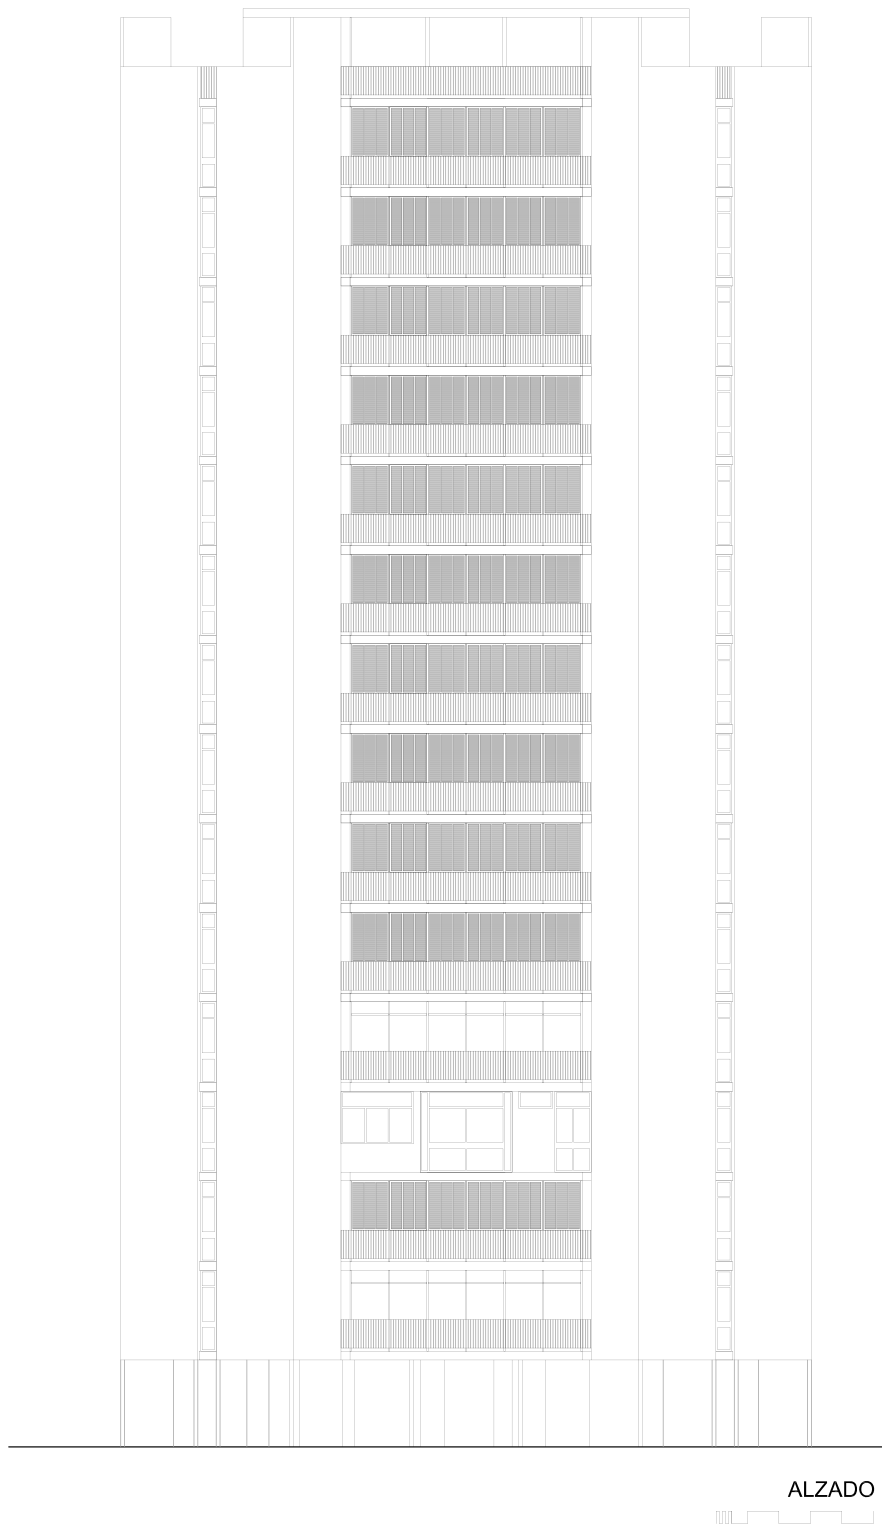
Alzado 1 de la Torre Hexagonal. Elaboración propia
